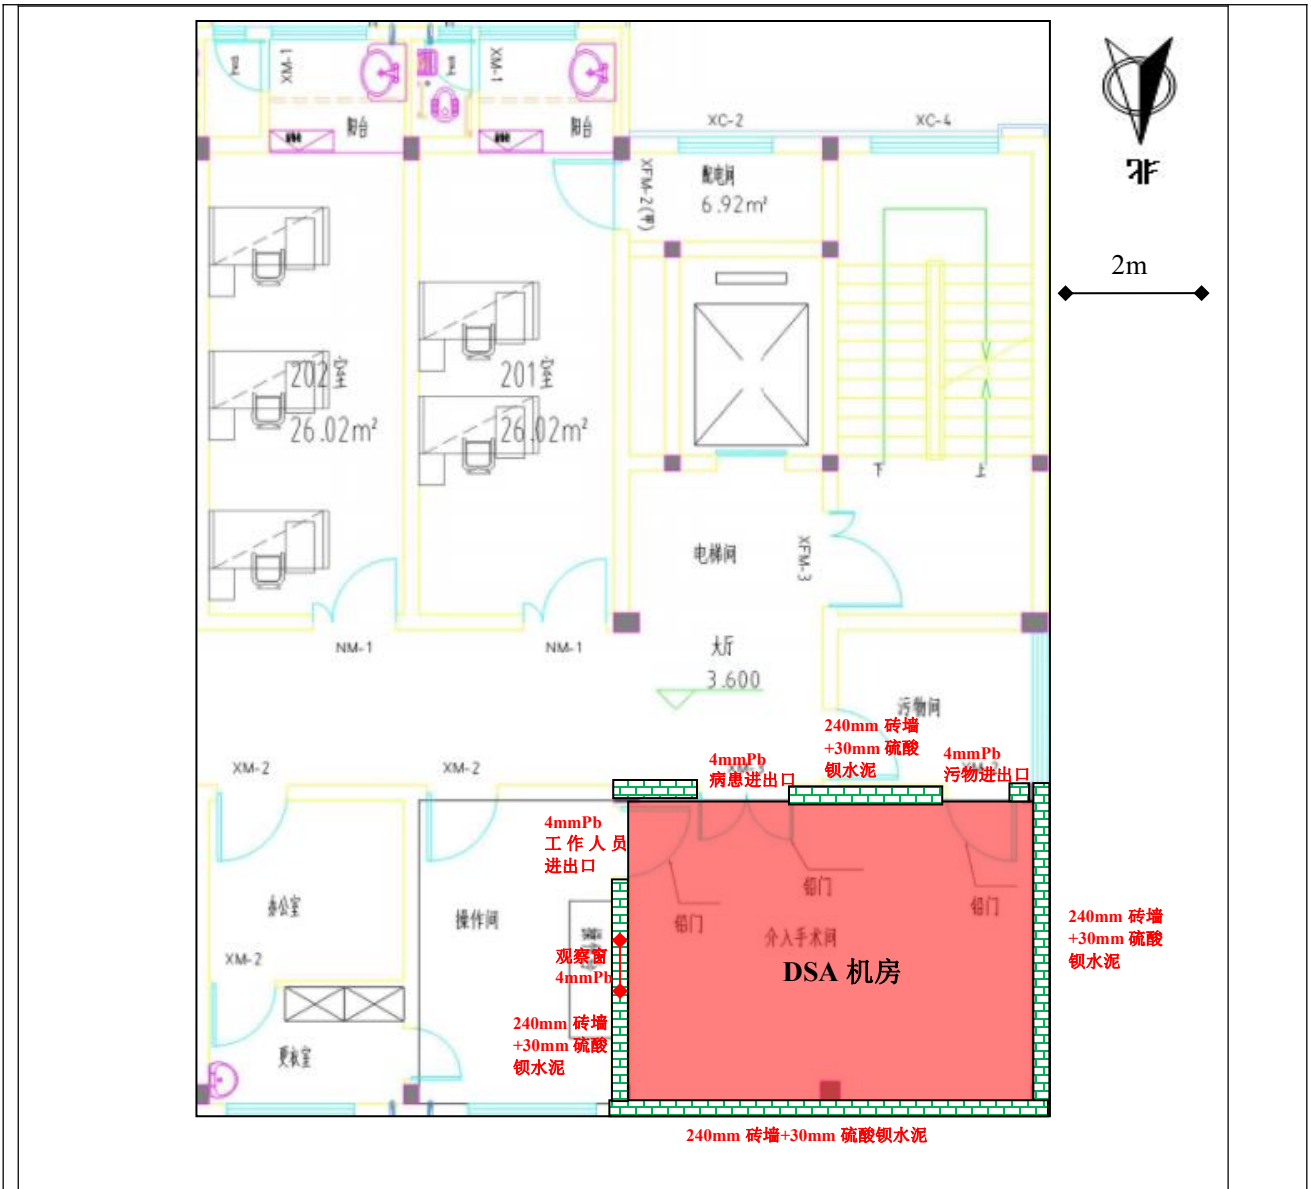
本项目 DSA 机房辐射防护屏蔽平面布局示意图
